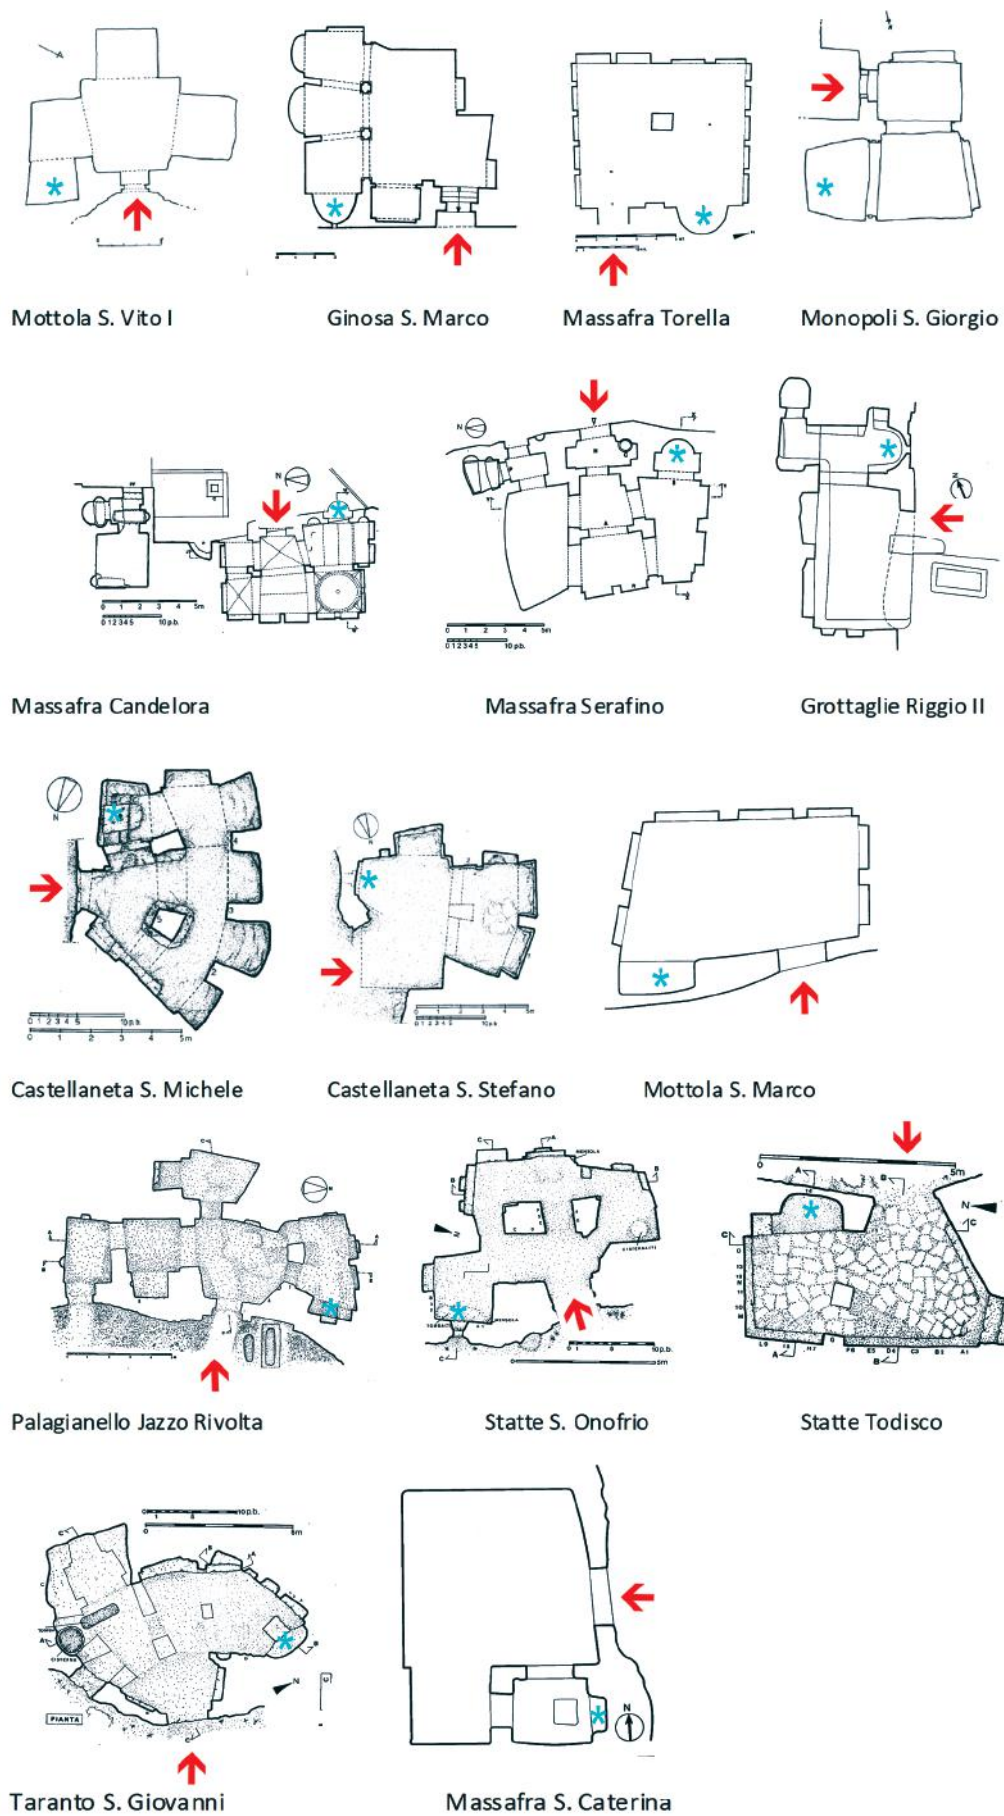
esempi di chiese rupestri a “pianta inversa”, cioè con ingresso e abside sullo stesso lato
